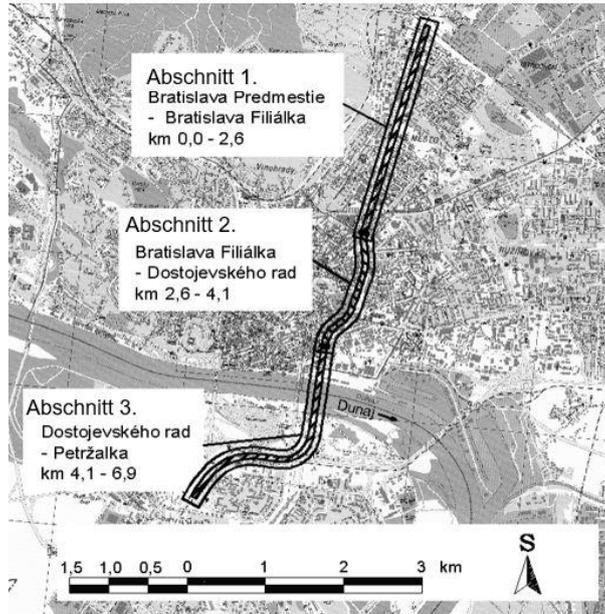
Lageplan des Interessengebiets in Bratislava und Längsprofil mit markierten Abschnitten des TEN-T-Eisenbahnkorridors
